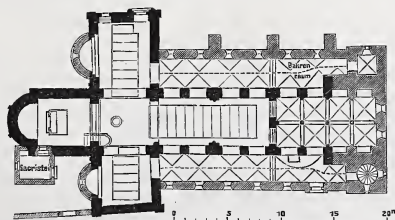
Grundriss nach der Wiederherstellung.
